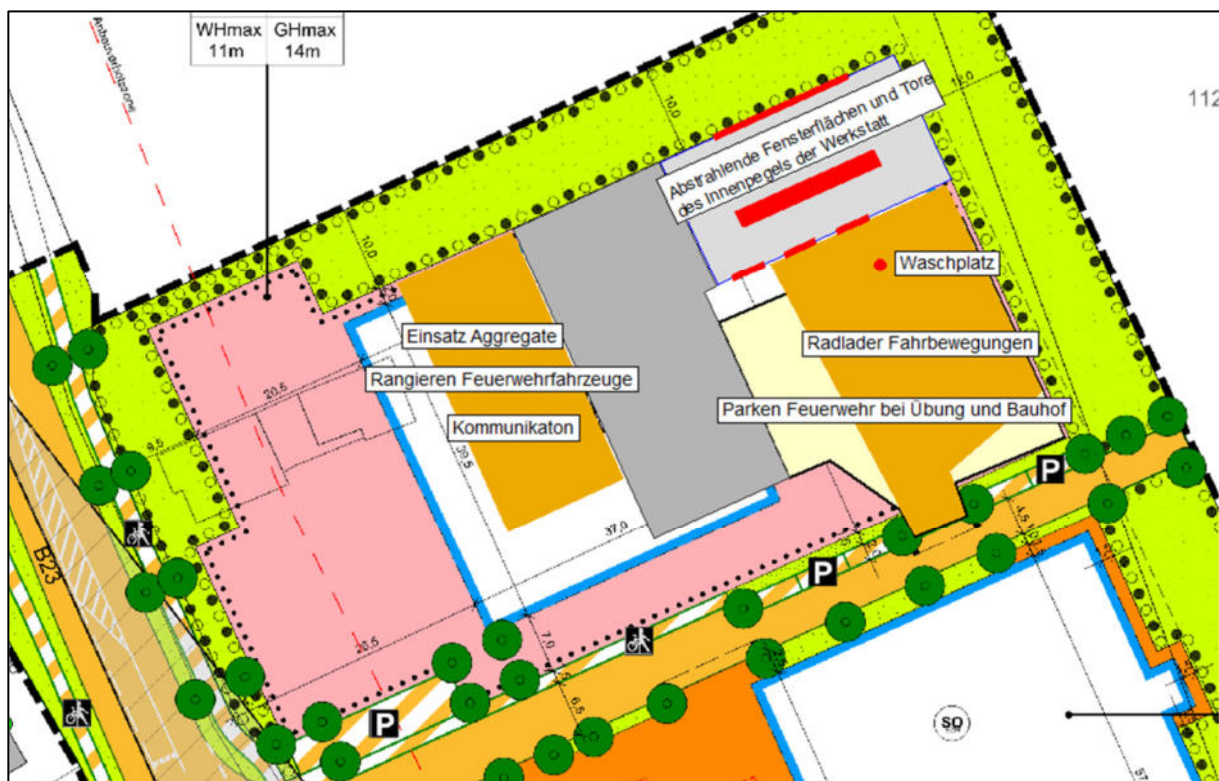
Bebauungsplan mit Modellansicht Feuerwehr (dunkelgrau) und Bauhof (hellgrau) mit Lage der Emissionen
